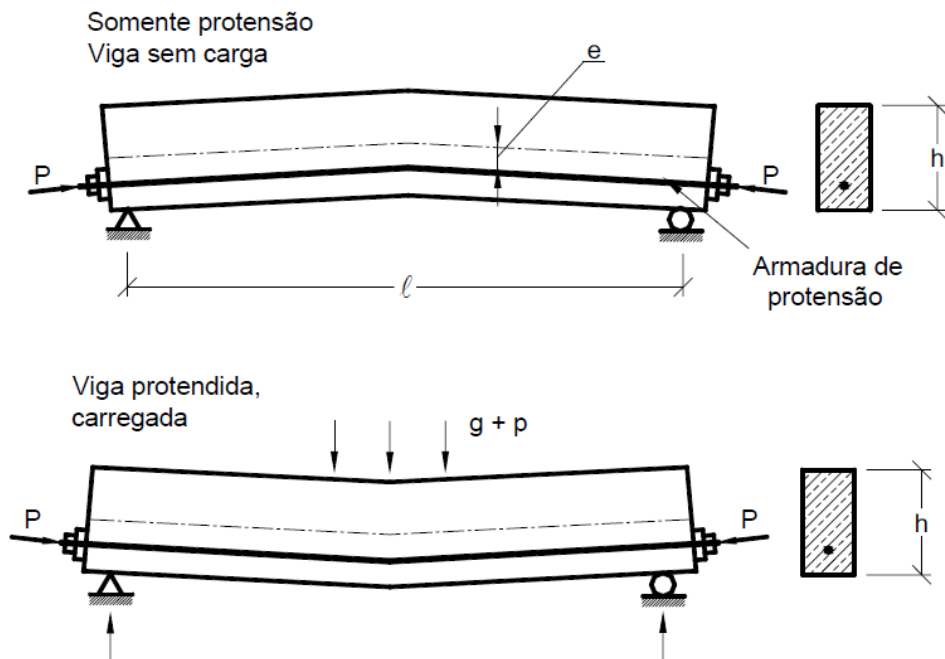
Aplicação de força de protensão em viga bi-apoiada
